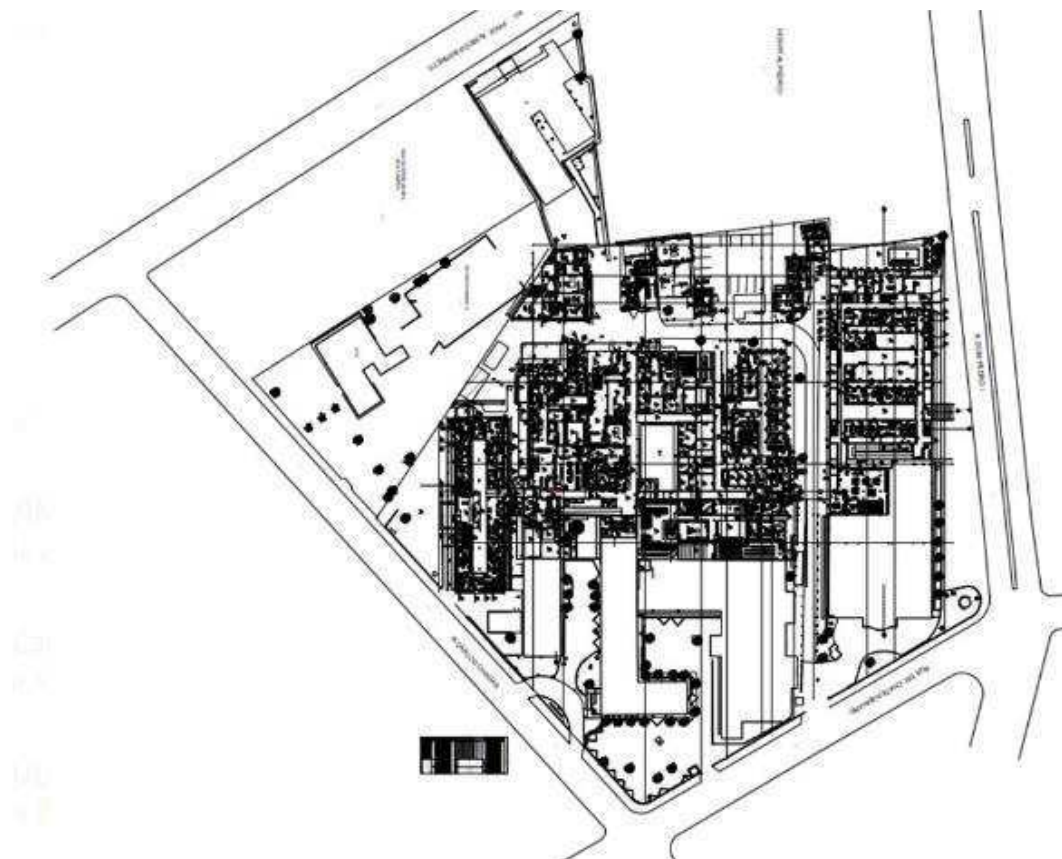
Planta baixa do HU-UFPG / Fonte: Setor de Infraestrutura Física – SIF
